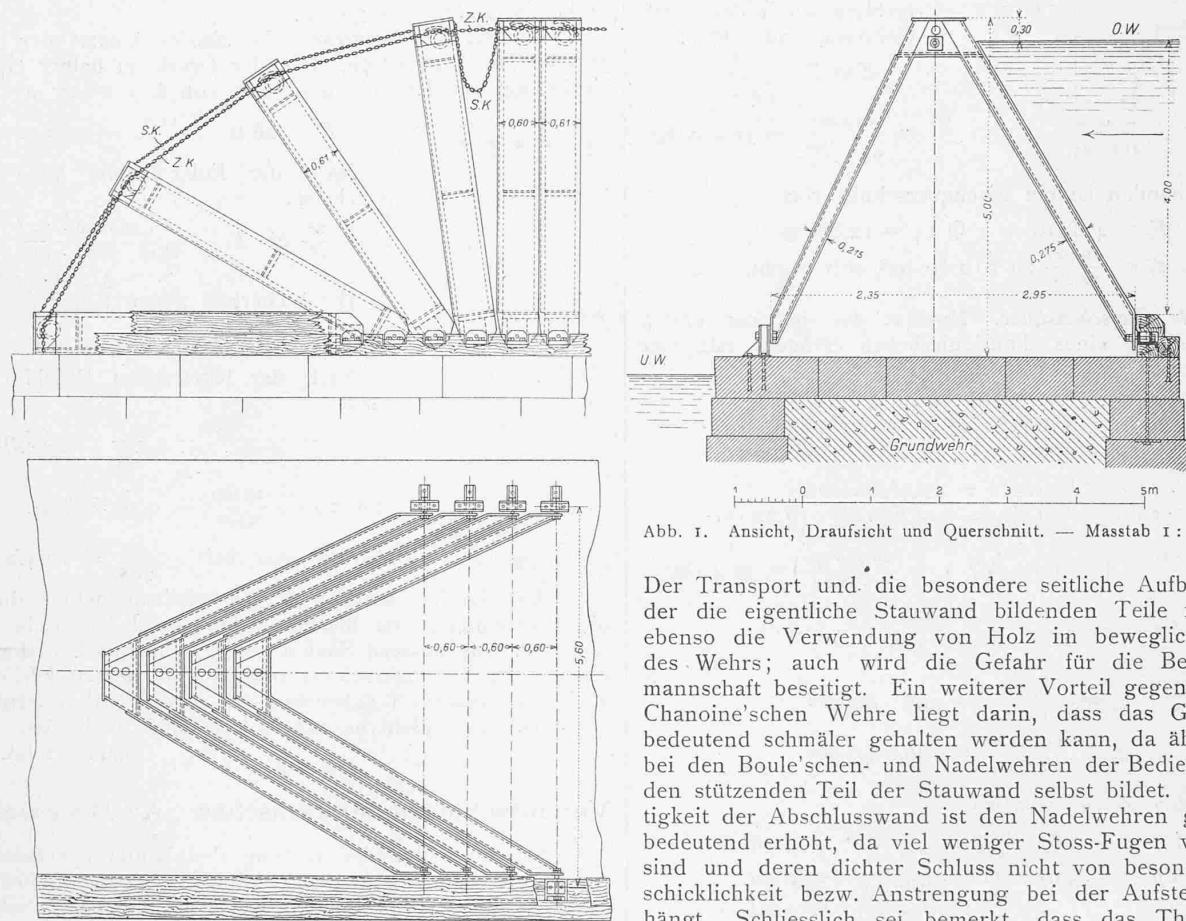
Ansicht, Draufsicht und Querschnitt. — Maßstab 1:100.
